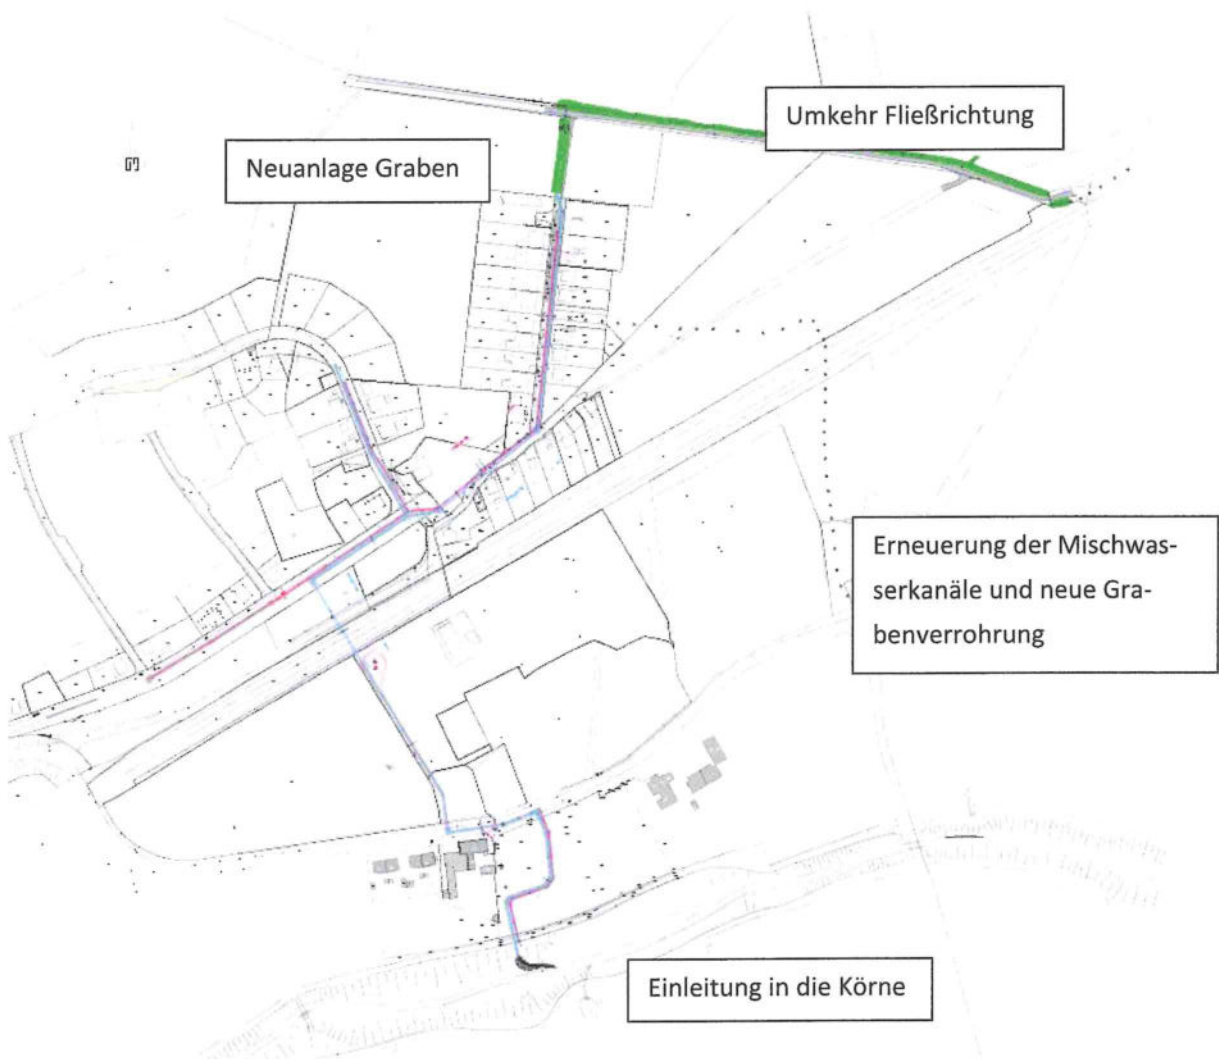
Lageplan [FISCHER TEAMPLAN 2021].
